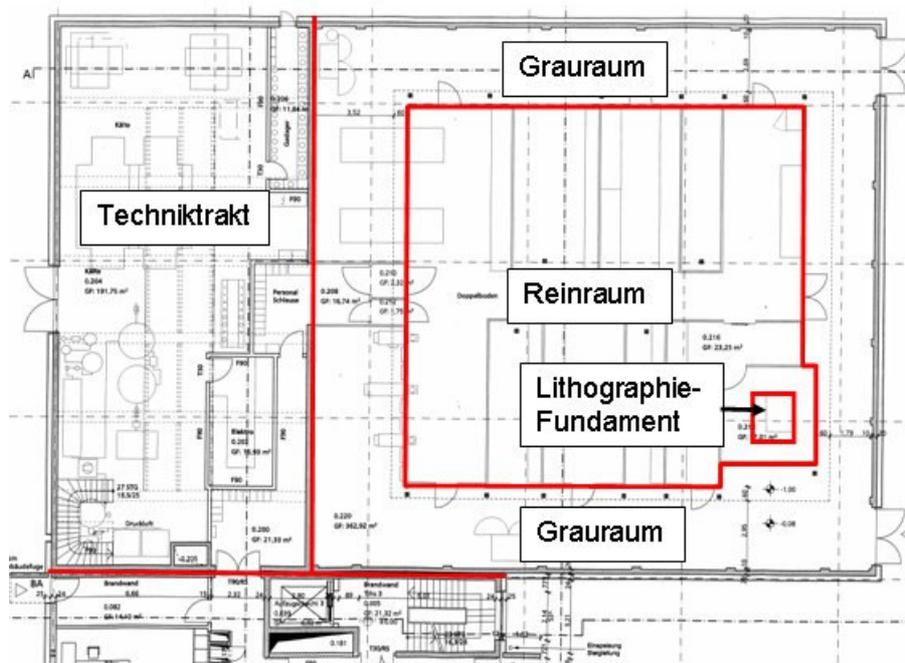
Grundriss der einzelnen Bauteile, rot: Gebäudetrennfugen
